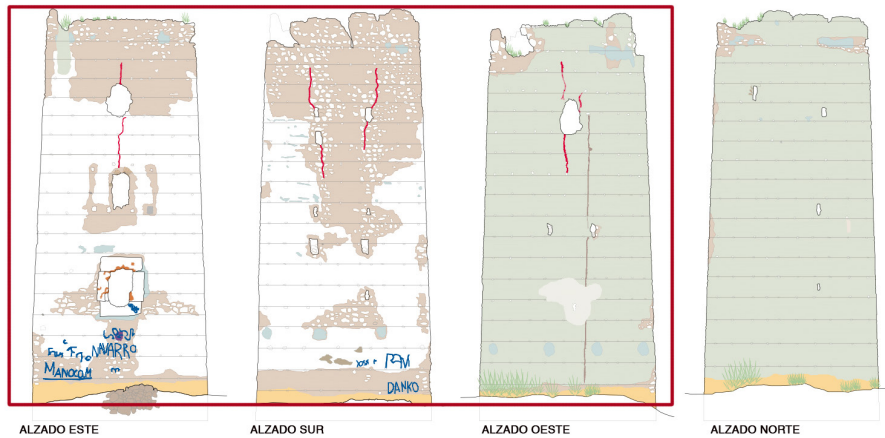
8.40. Detalles de la pérdida de masa en el alzado Sur y Este.
